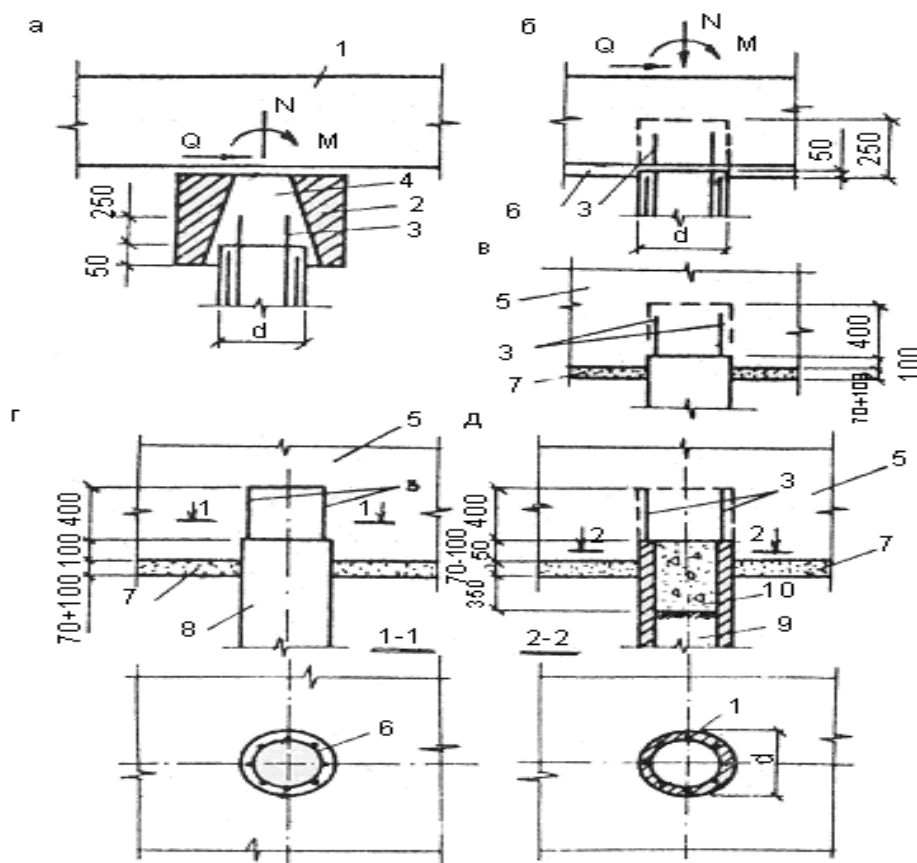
Жесткое сопряжение свай с ростверком: а – соединение головной части сваи с насадкой; б, в – соединение ростверка со свайей прямоугольного сечения; г, д – соединение круглых свай с ростверком; 1- надфундаментная конструкция; 2 - насадка; 3 – выпуски арматуры; 4 – полость, заполняемая бетоном; 5 – ростверк; 6 – спиральный хомут; 7 – подготовка; 8 – круглая свая сплошного сечения; 9 – грунтовое ядро полый сваи; 10 – круглая полая свая
